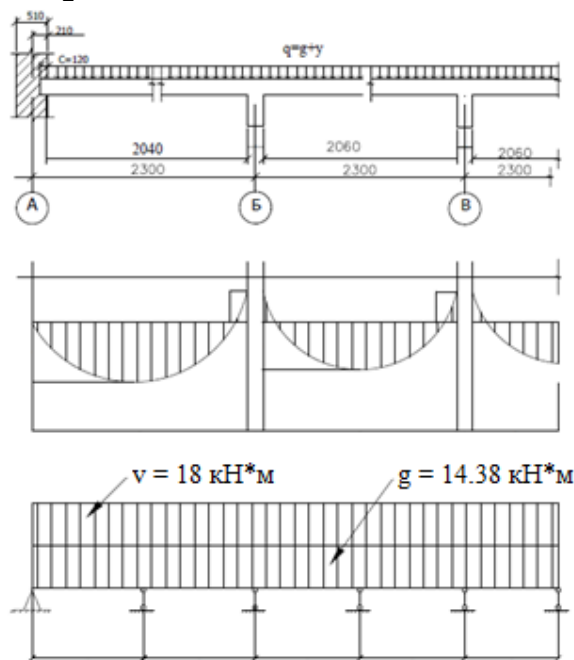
Расчетная схема монолитной балочной плиты
